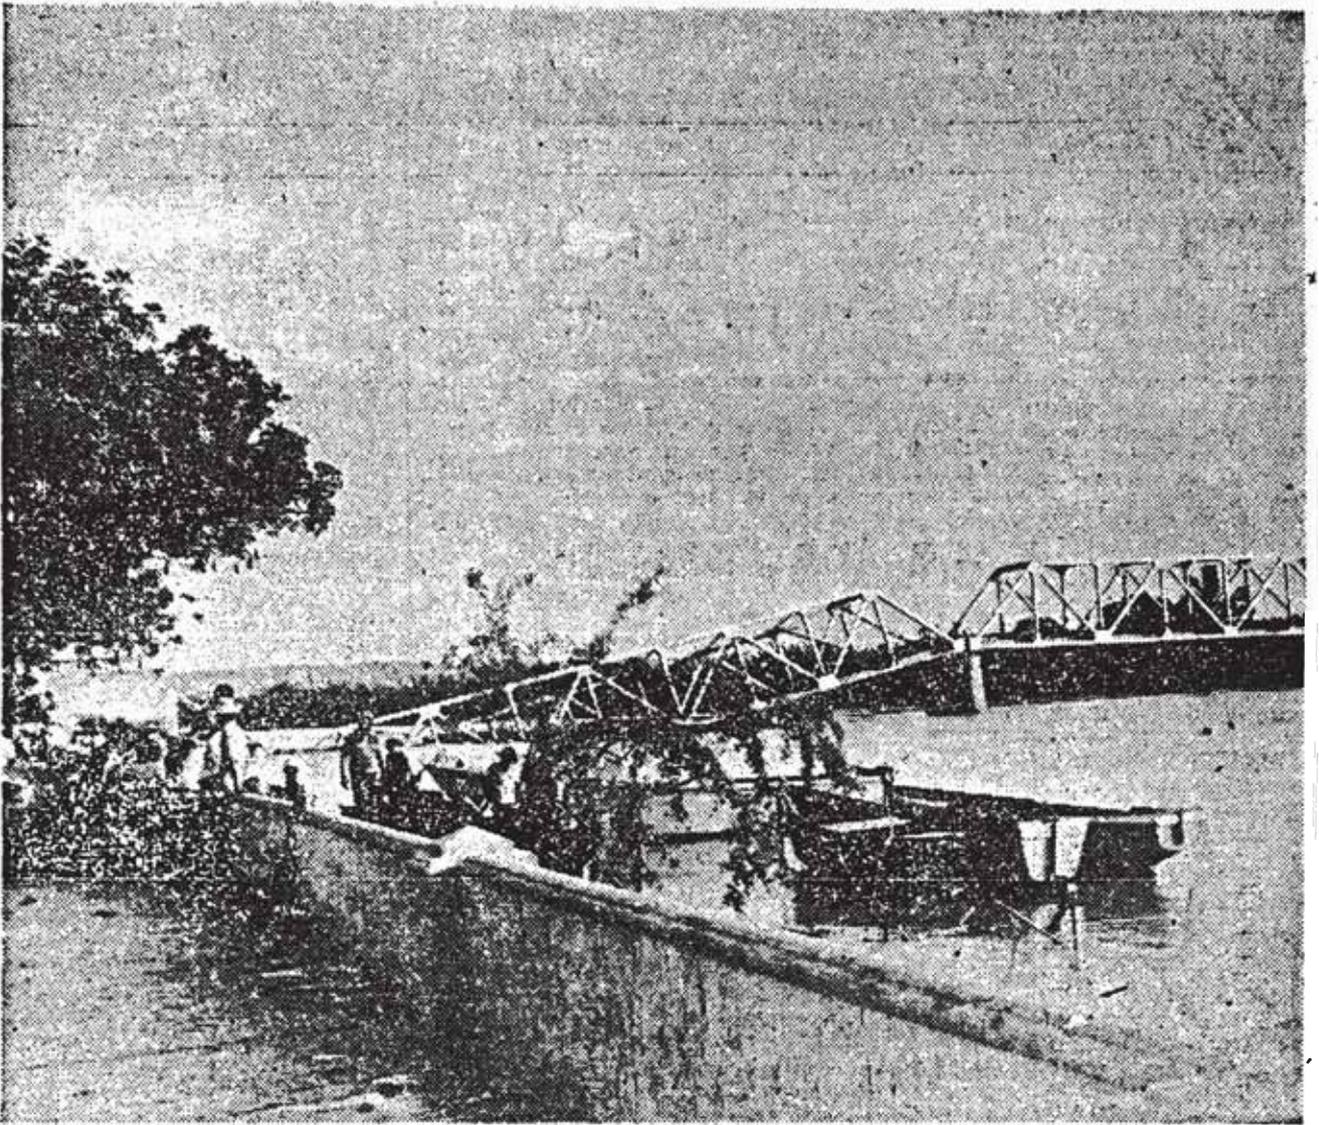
y 49 - Vistas del Puente Viejo, al colapsar el estribo derecho.
